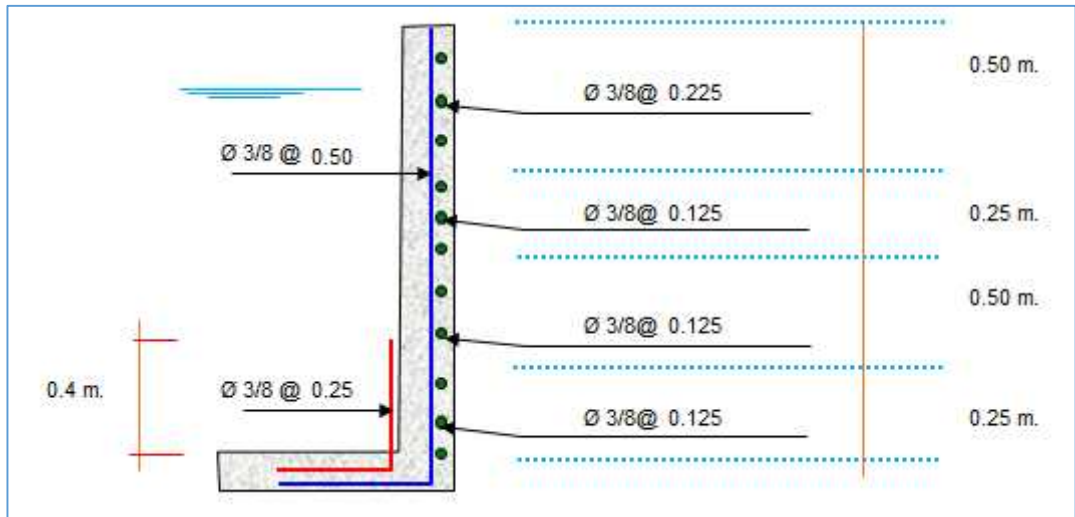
Detalle de la disposición final del acero en las paredes del reservorio
